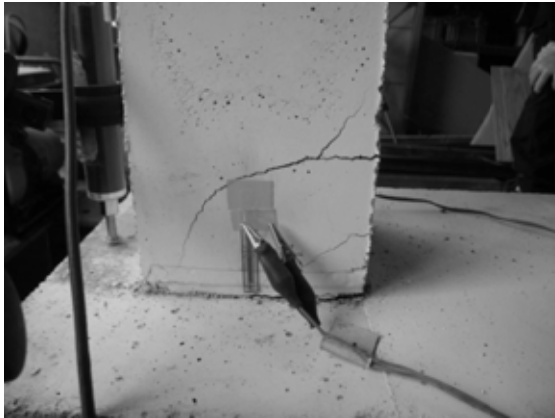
ひび割れ性状 (Fc21C-2)
